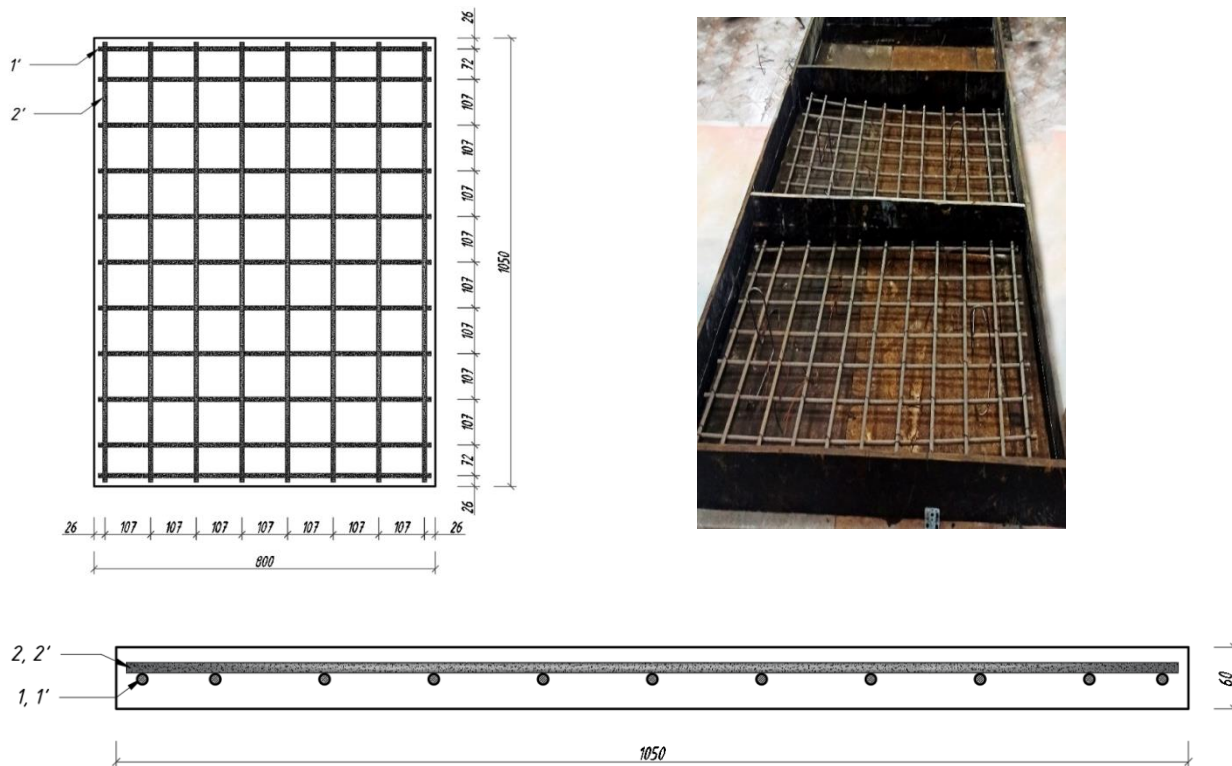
Армирование опытных образцов: а) рабочая схема армирования плит на плане; б) рабочая схема армирования плит в продольном разрезе;
